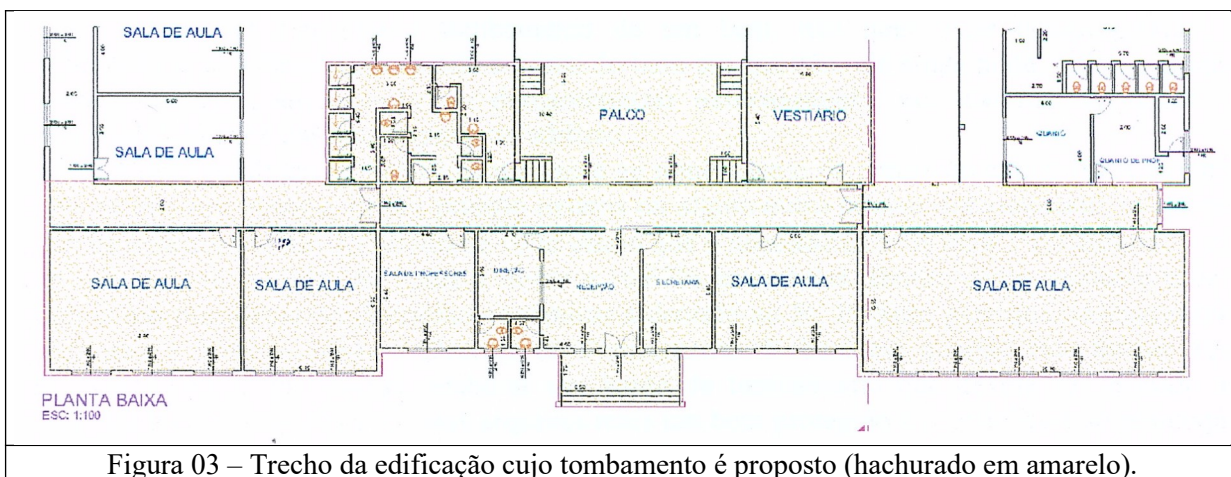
Trecho da edificação cujo tombamento é proposto (hachurado em amarelo).
